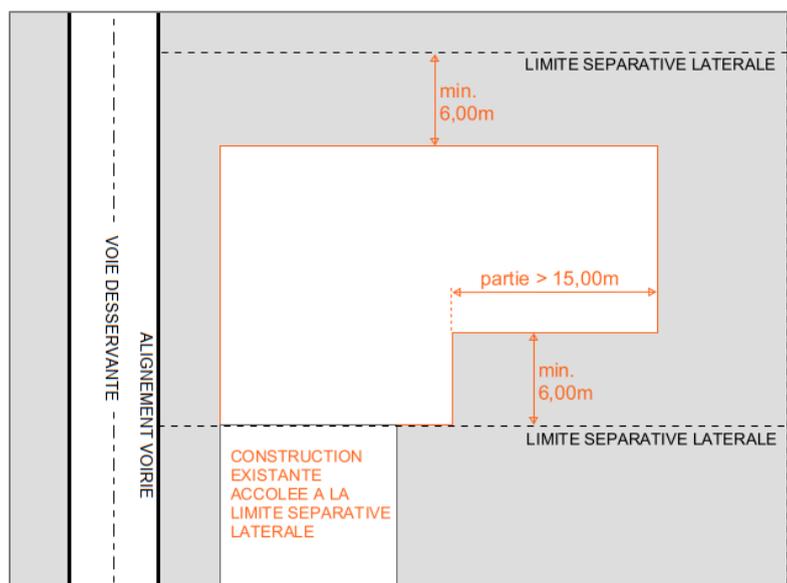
Implantation perpendiculaire d'une construction dont le côté le plus long est supérieur à 15,00 m et construction existante accolée à la limite séparative
